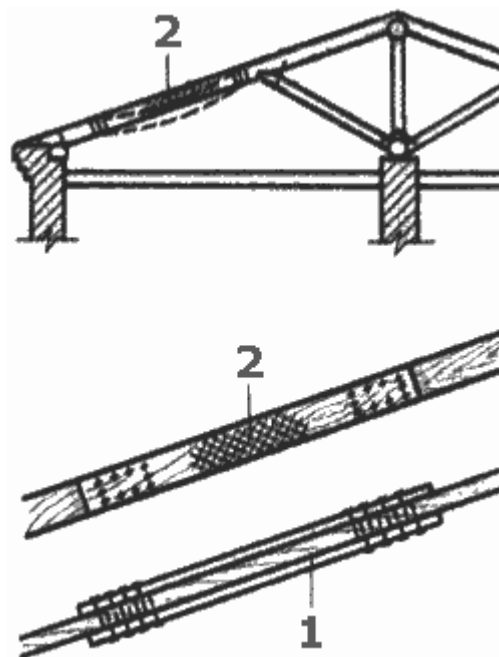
Усиление стропильной ноги в средней части накладками: 1 - накладки и подкосы из досок; 2 - сгнившая часть стропильной ноги.
